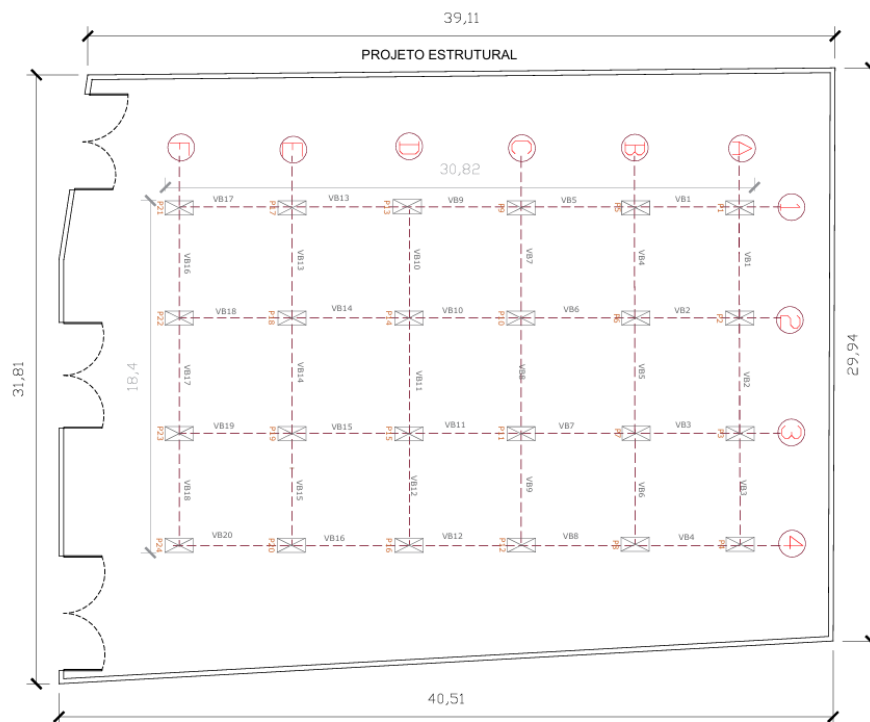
Planta do Projeto Estrutural Fonte: dos autores, 2024
